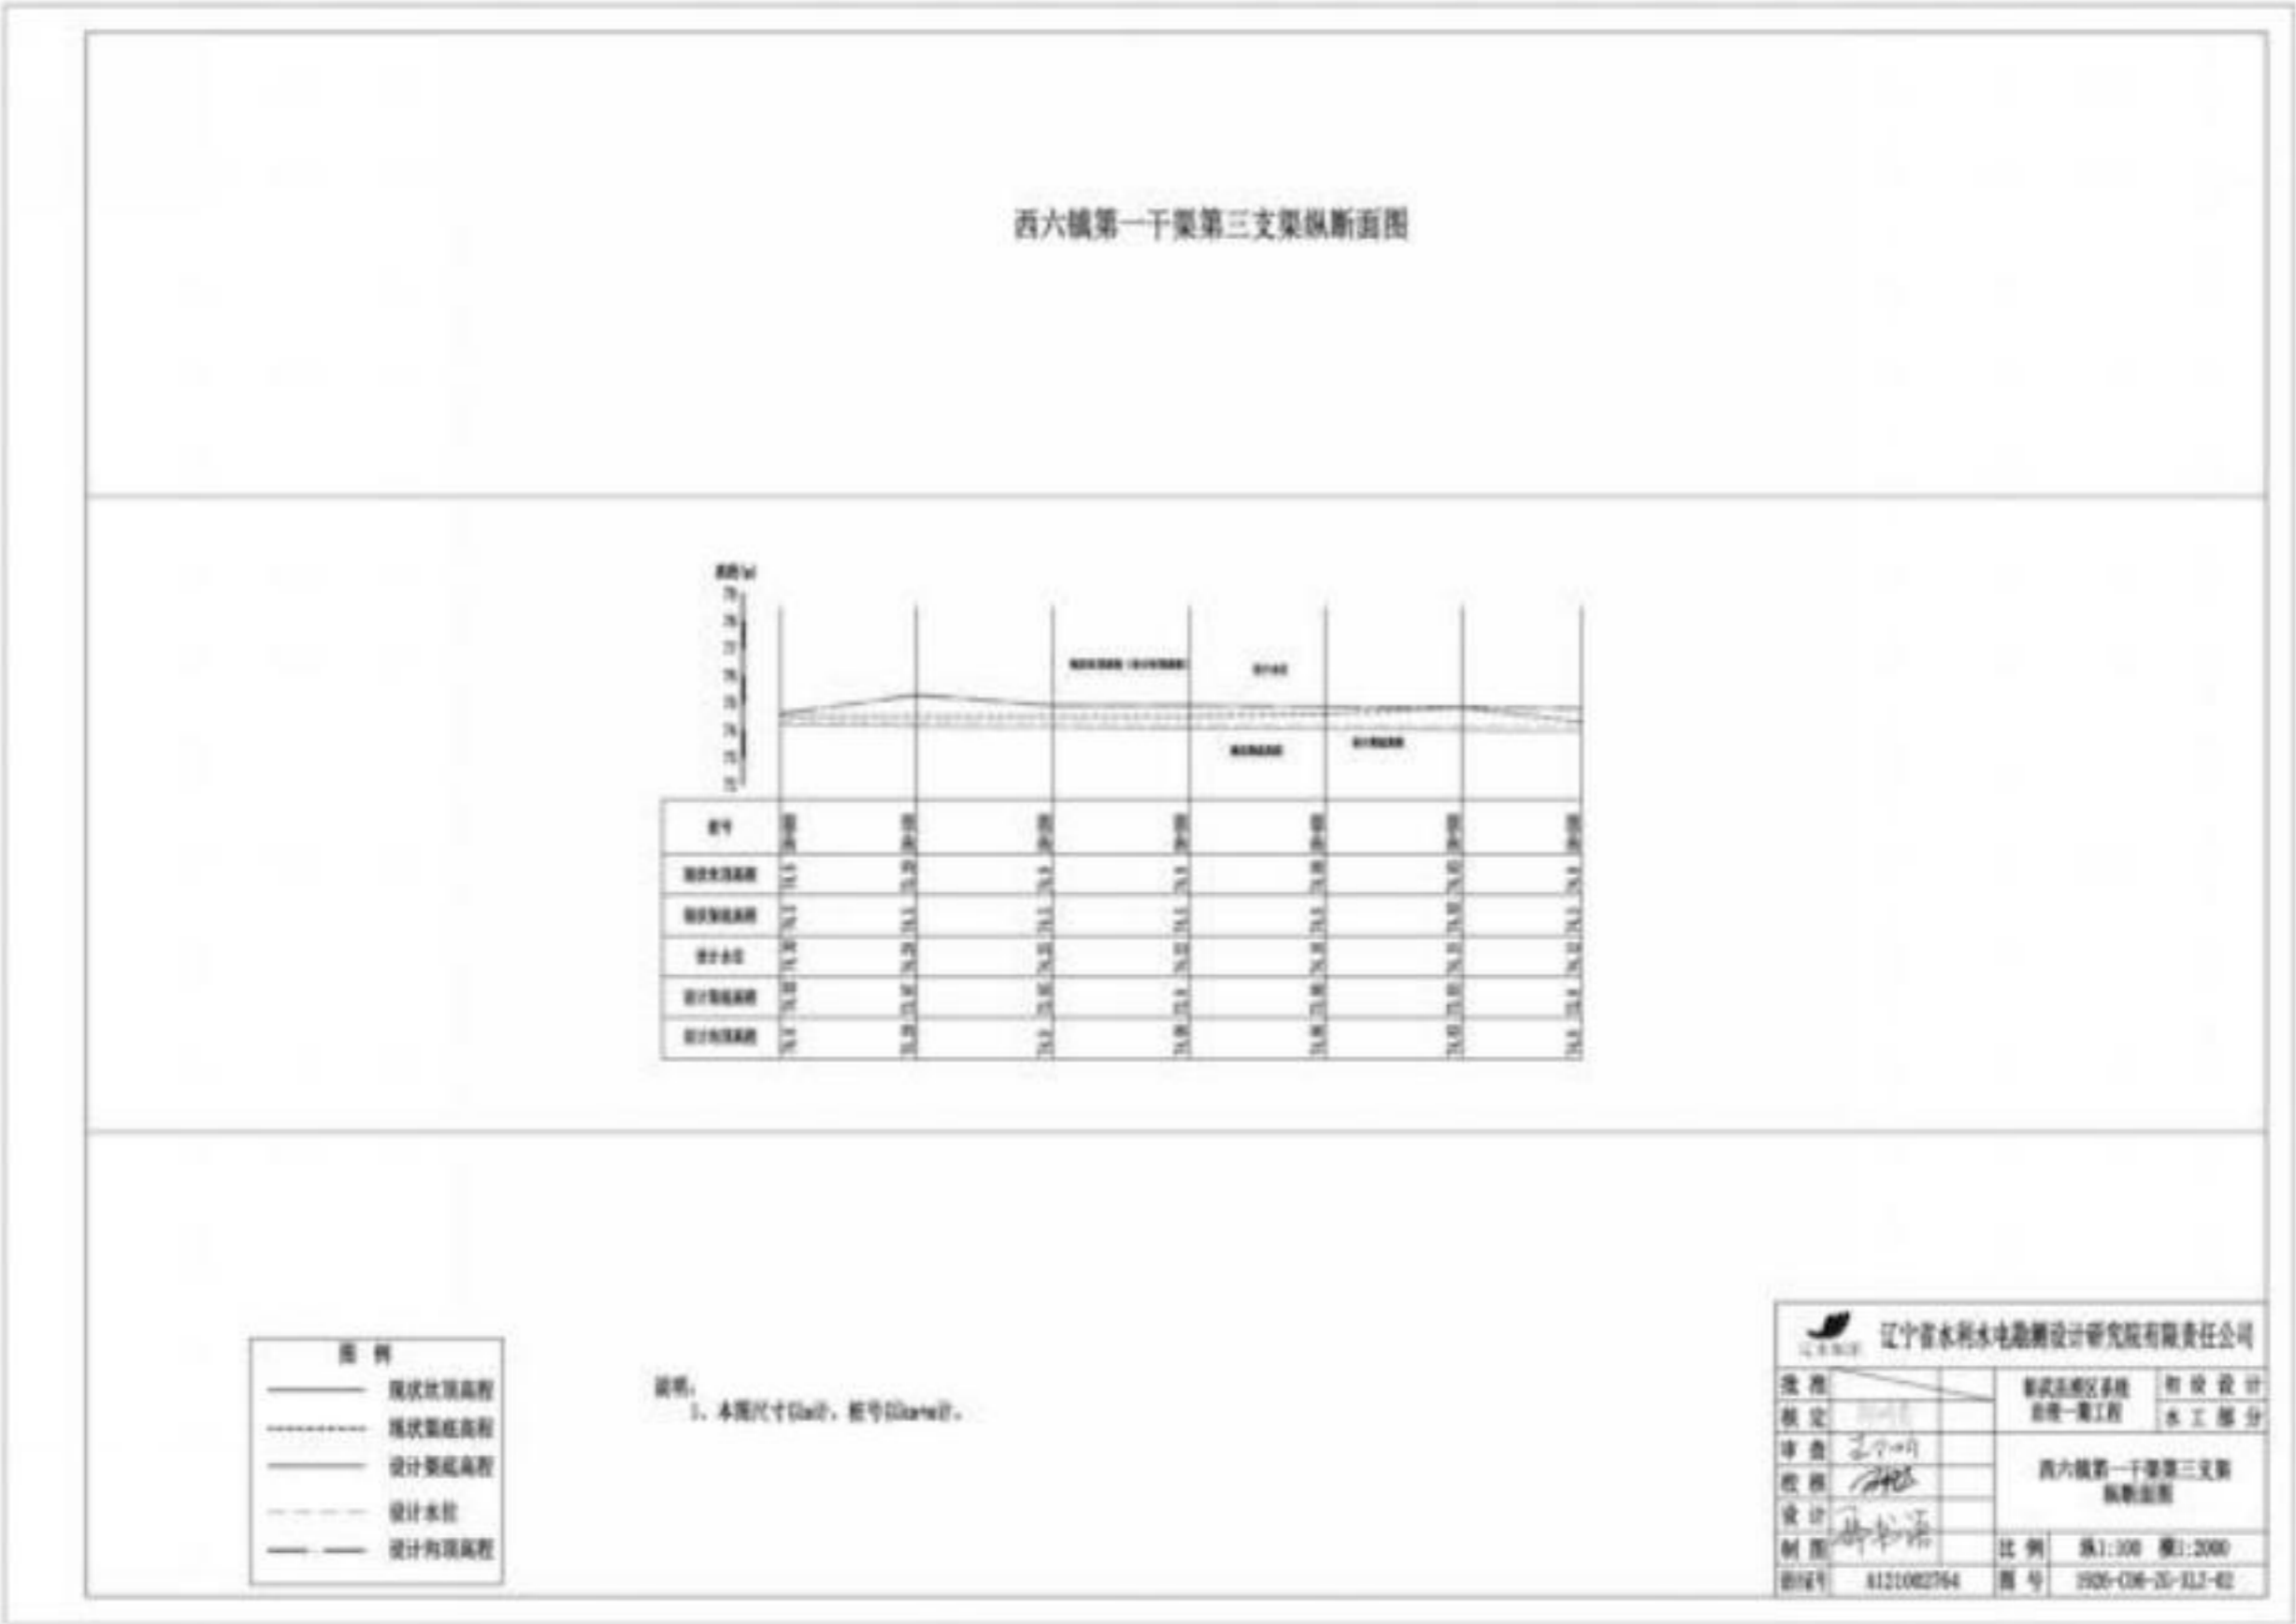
西六镇第一干渠第三支渠纵断面图
